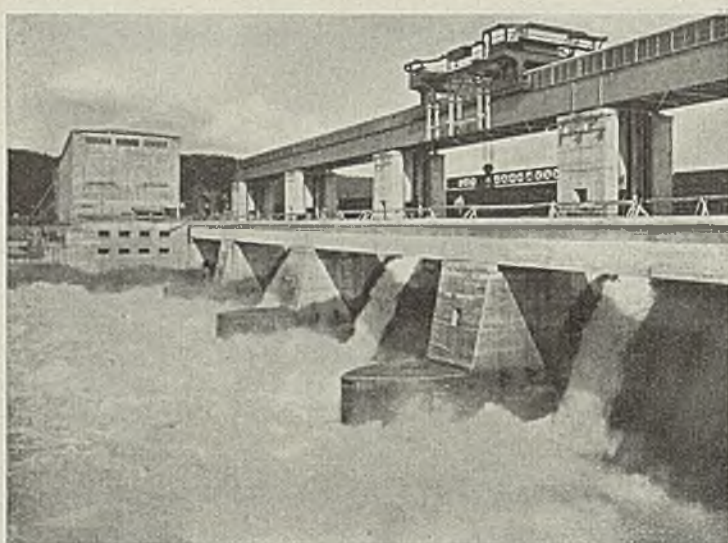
Stauwehr. Ansicht vom Unterwasser (Südufer).
